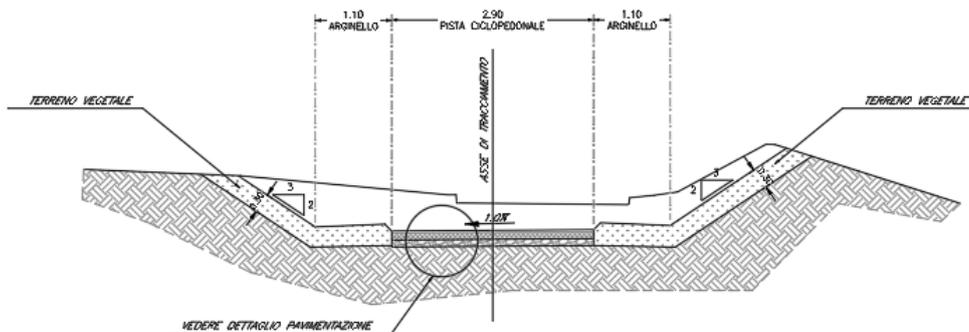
Sezione tipo Pista ciclopedonale.
